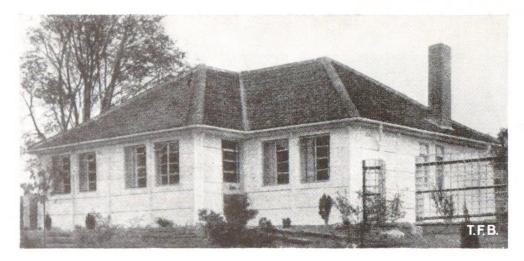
Maison d'habitation construite en pièces détachées en béton. (D'après Concrete Building, No 1, 1946, Londres)
